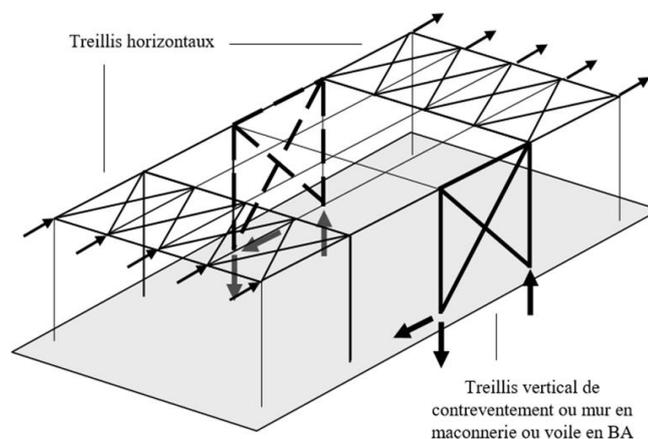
Stabilisation longitudinale d'un bâtiment industriel par contreventement
